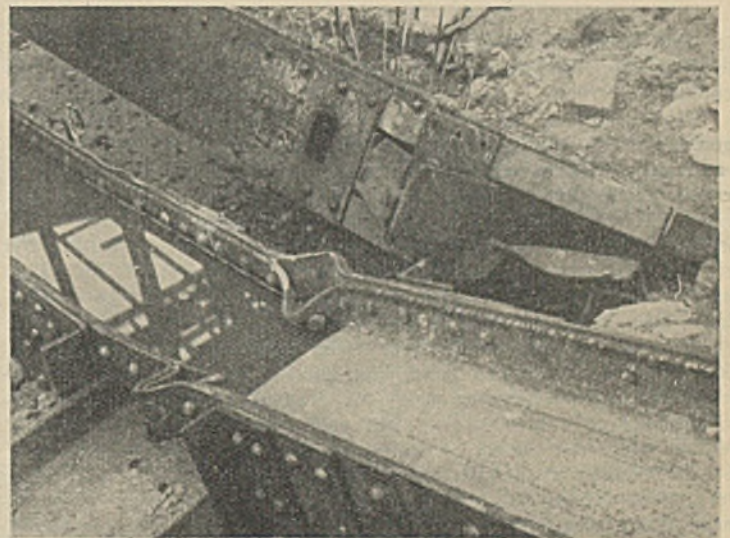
Verformung einer Stütze am Unterzuganschluß durch den Einsturz.
